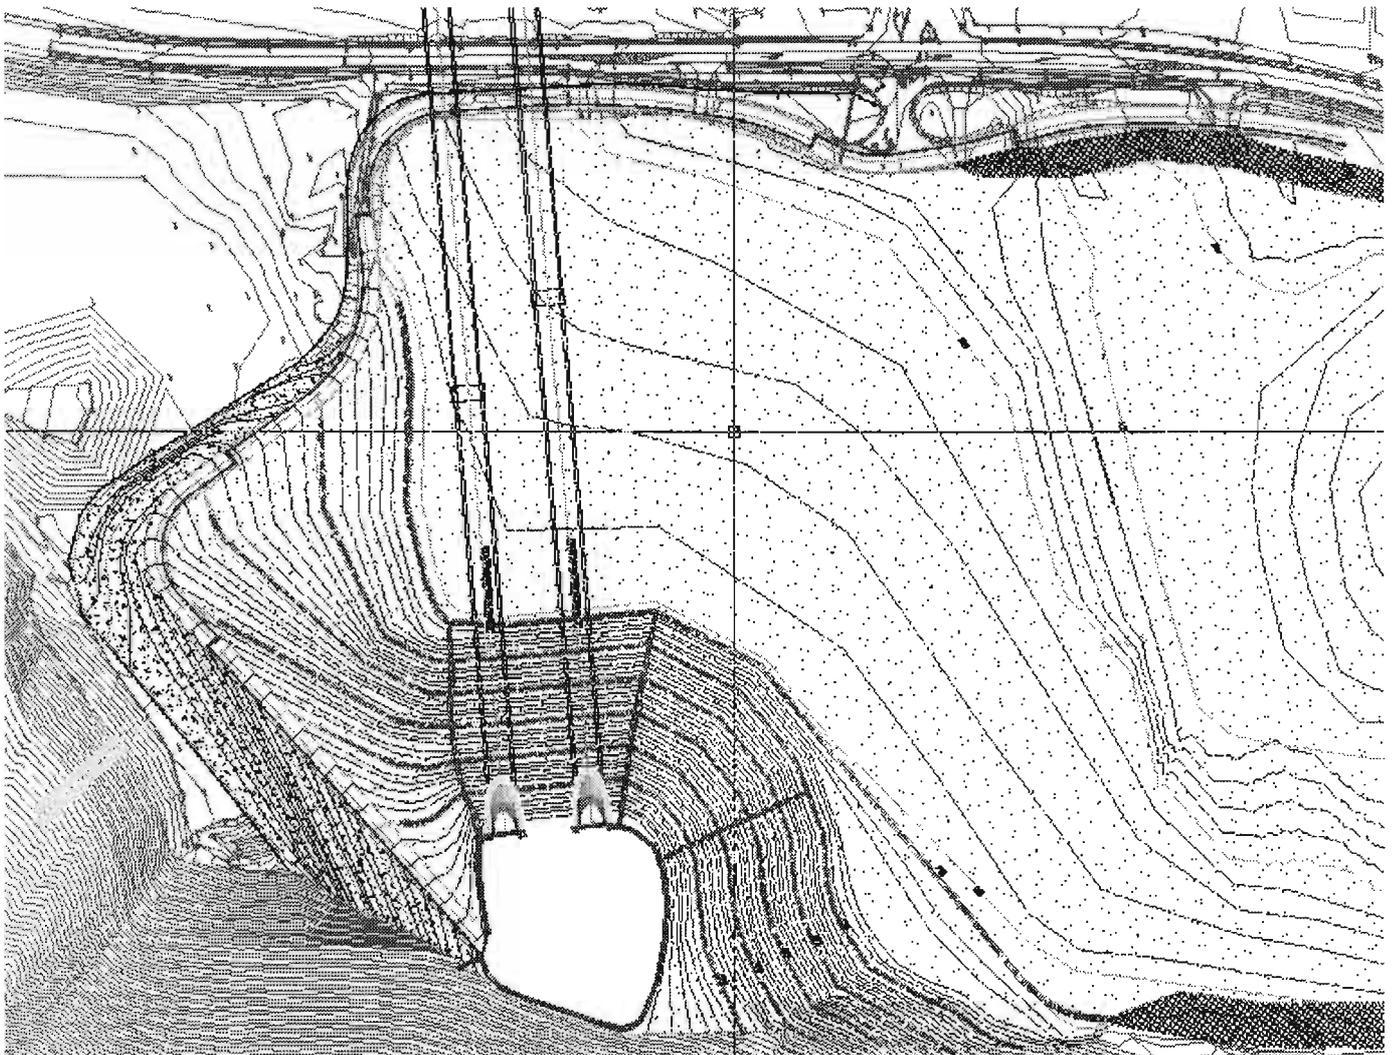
Schema planimetrico Cantierizzazione Forch Fase Definitiva
